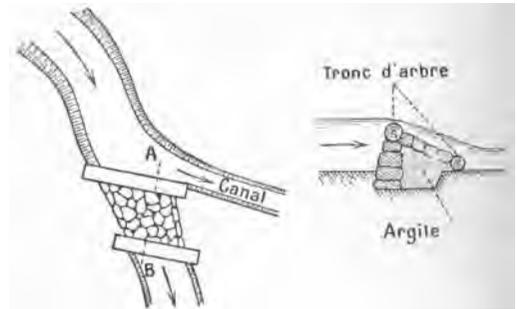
Barrage sur torrent. 1. Vue en plan: 2. Coupe suivant A B.
